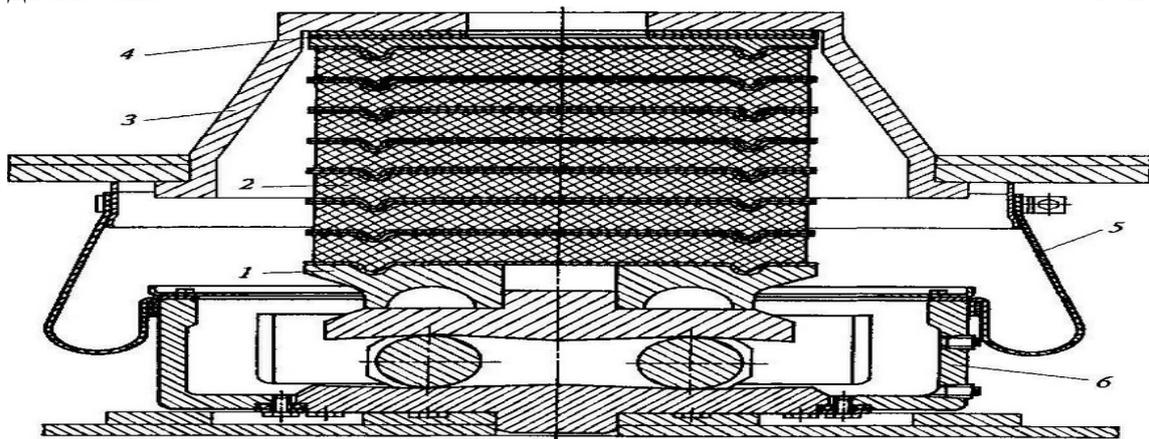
Резинороликовая опора: 1 - опорная плита; 2 - резинометаллический элемент; 3 - стакан; 4 - регулировочная пластина; 5 - чехол; 6 - роликовая опора
